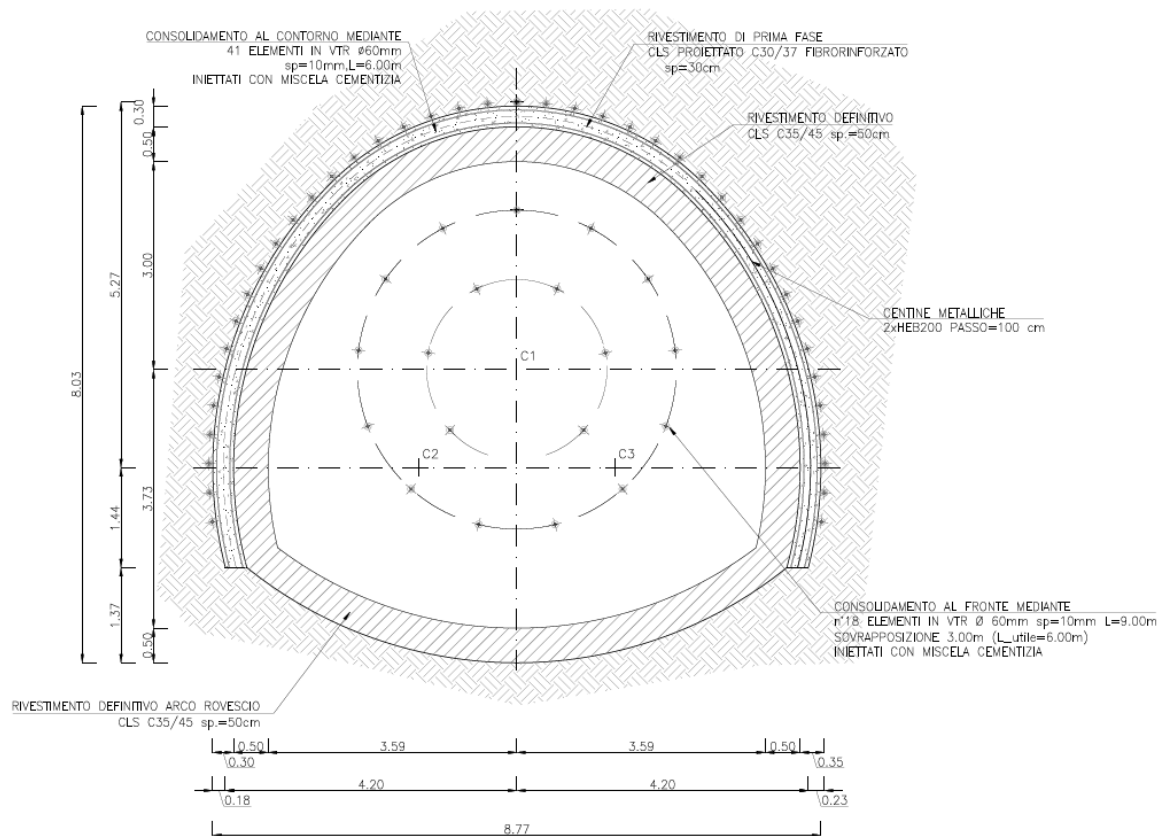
Sezione tipo GV-4: geometria del cavo e interventi di sostegno, sezione trasversale
